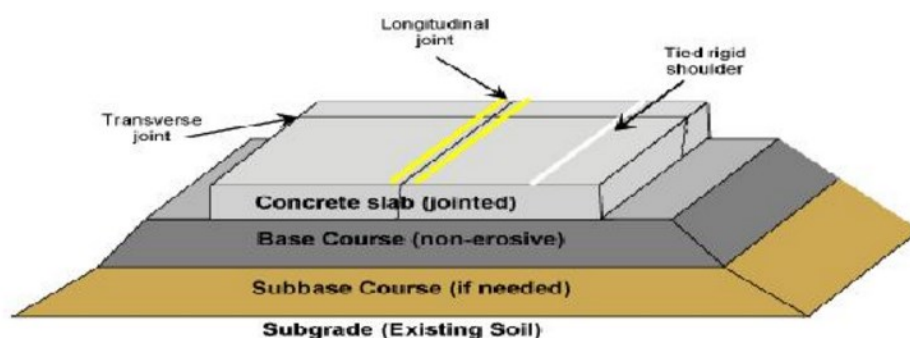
1. Stratigrafia di una Pavimentazione Rigida.
